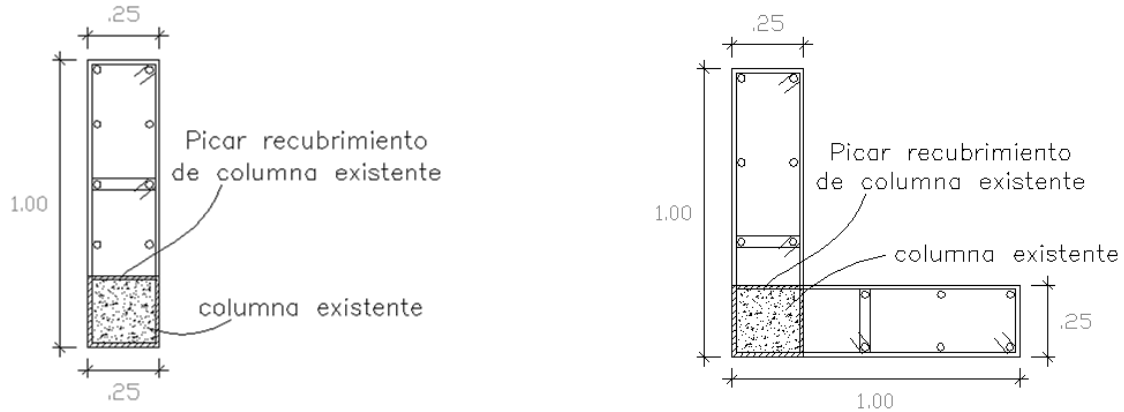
Detalle de reforzamiento para columna existente y esquinera.
